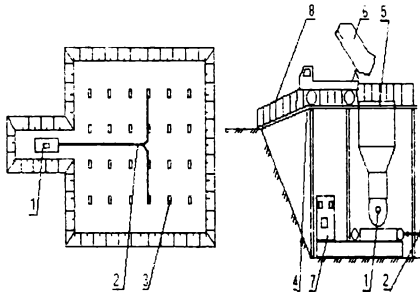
Подача бетонной смеси бетононасосами.
